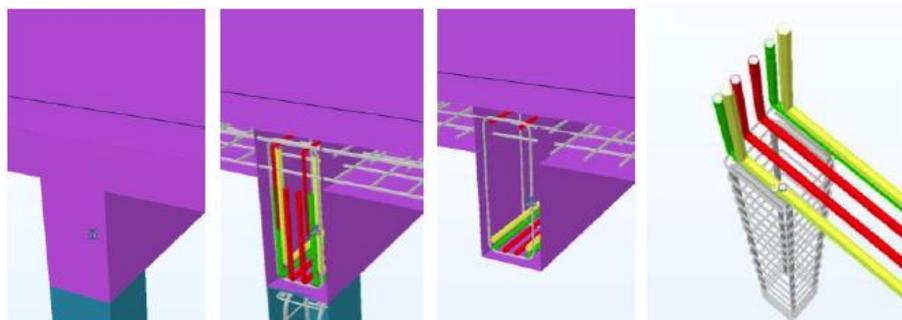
Modelo de viga de betão armado para apoio ao ensino em ‘Estruturas de Betão I’
